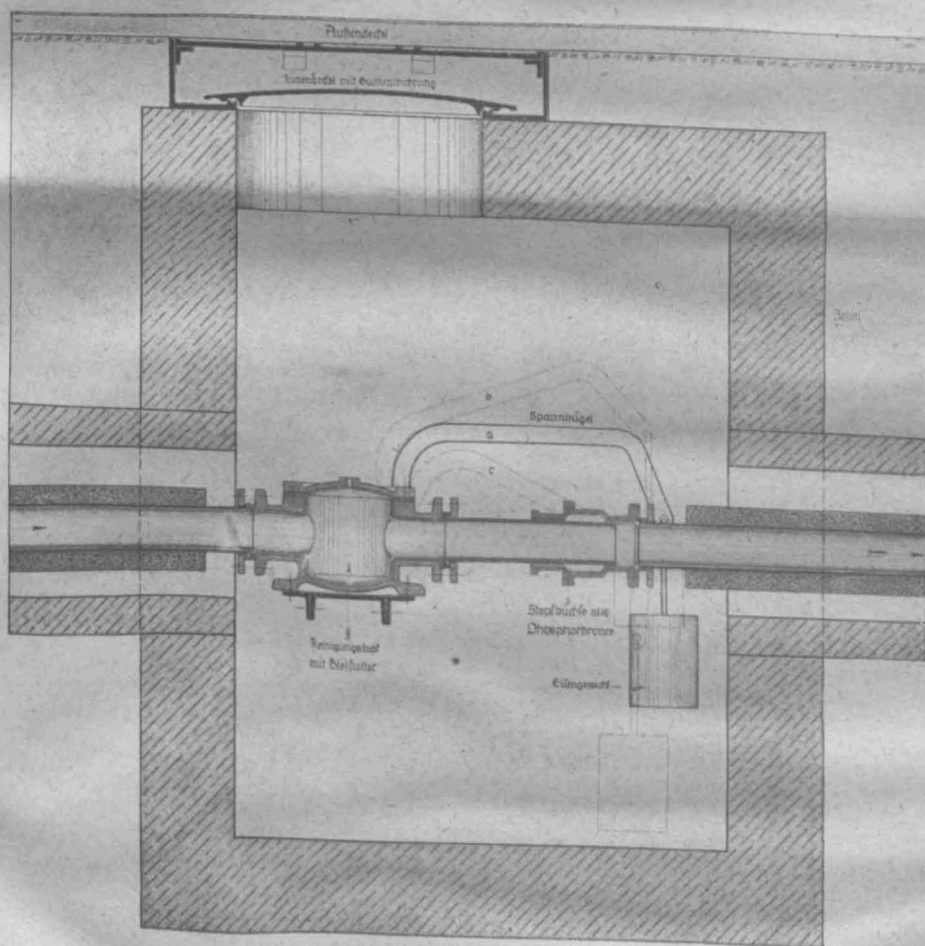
Längsschnitt durch den Schacht mit eingebauter Kompensations-Vorrichtung (1:20.)
